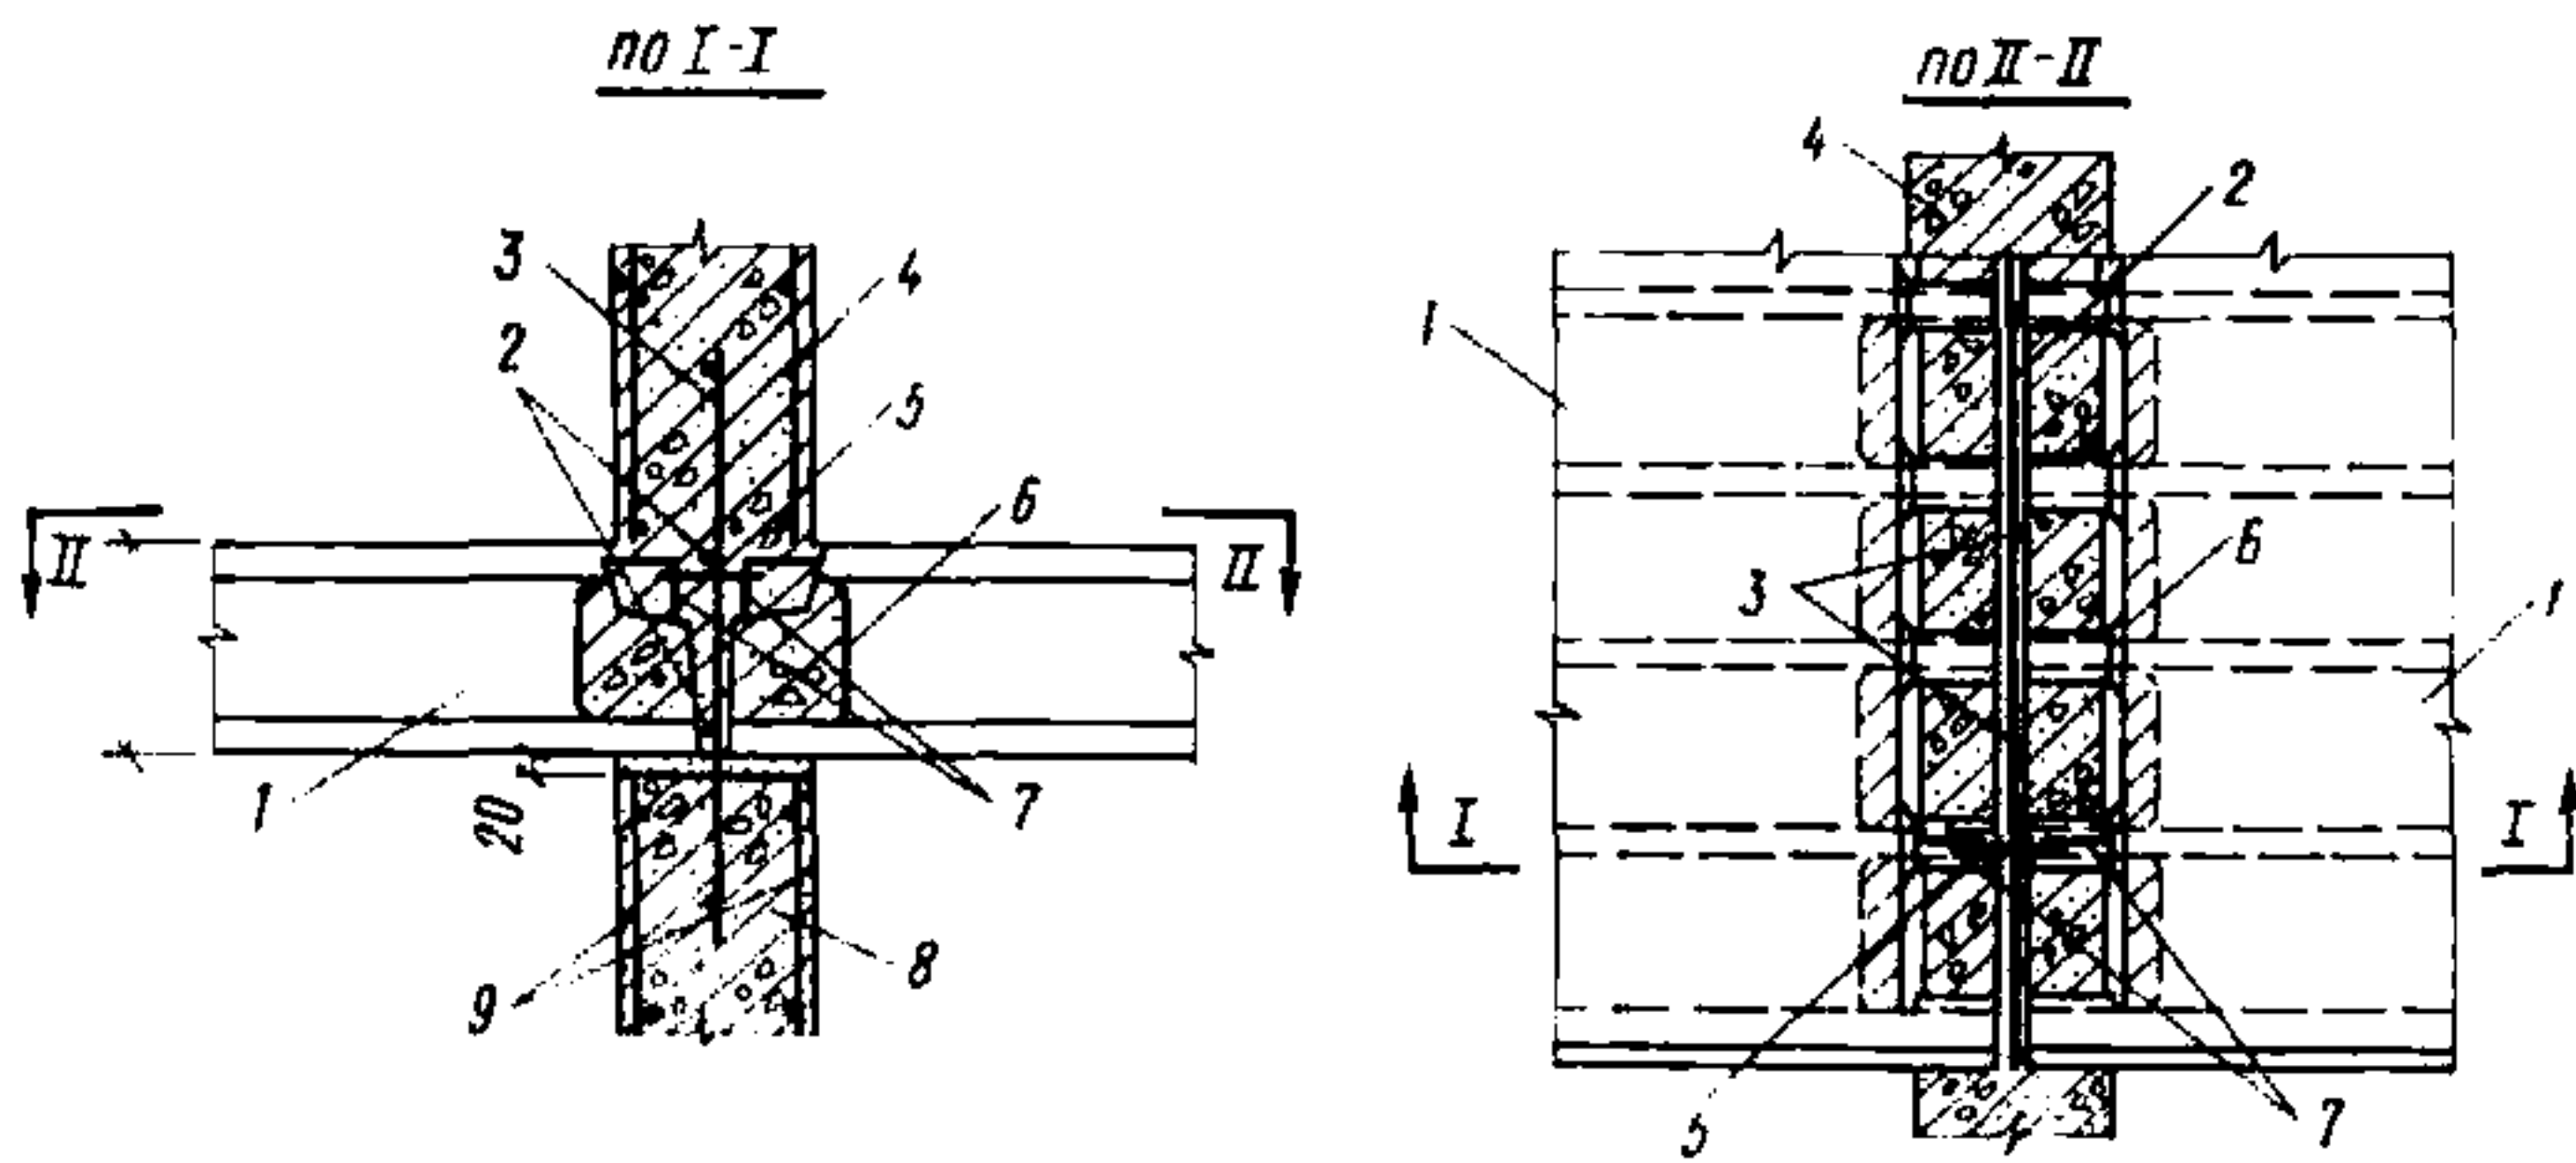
Горизонтальный стык монолитных стен и многопустотных плит настила со вскрытыми пустотами в опорной зоне стыка
